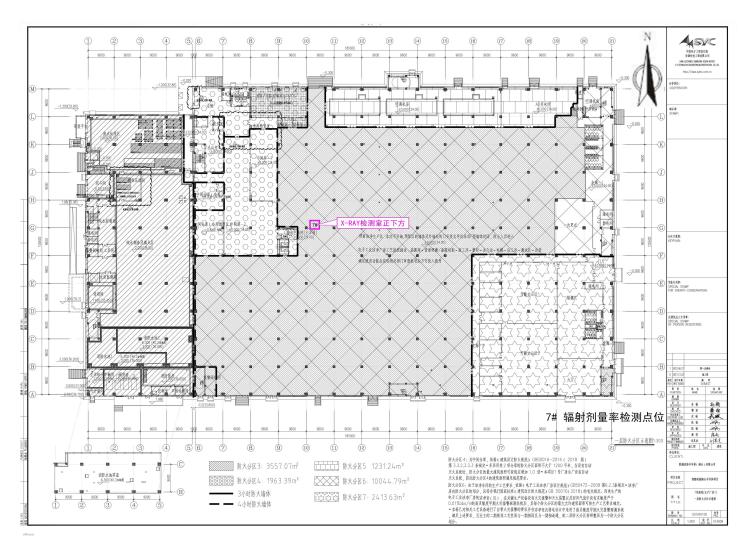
本项目所在生产厂房 1 一层平面布置示意图
